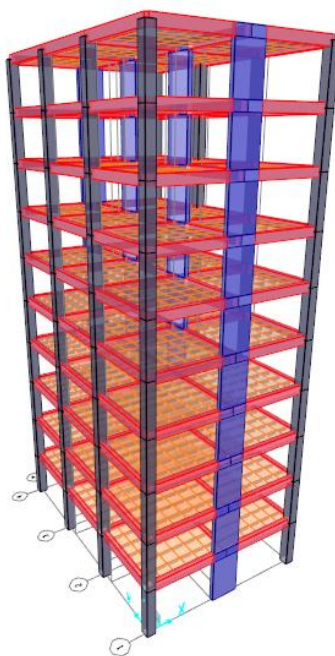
Modelo 3D da estrutura mista (Pórtico/Parede)
